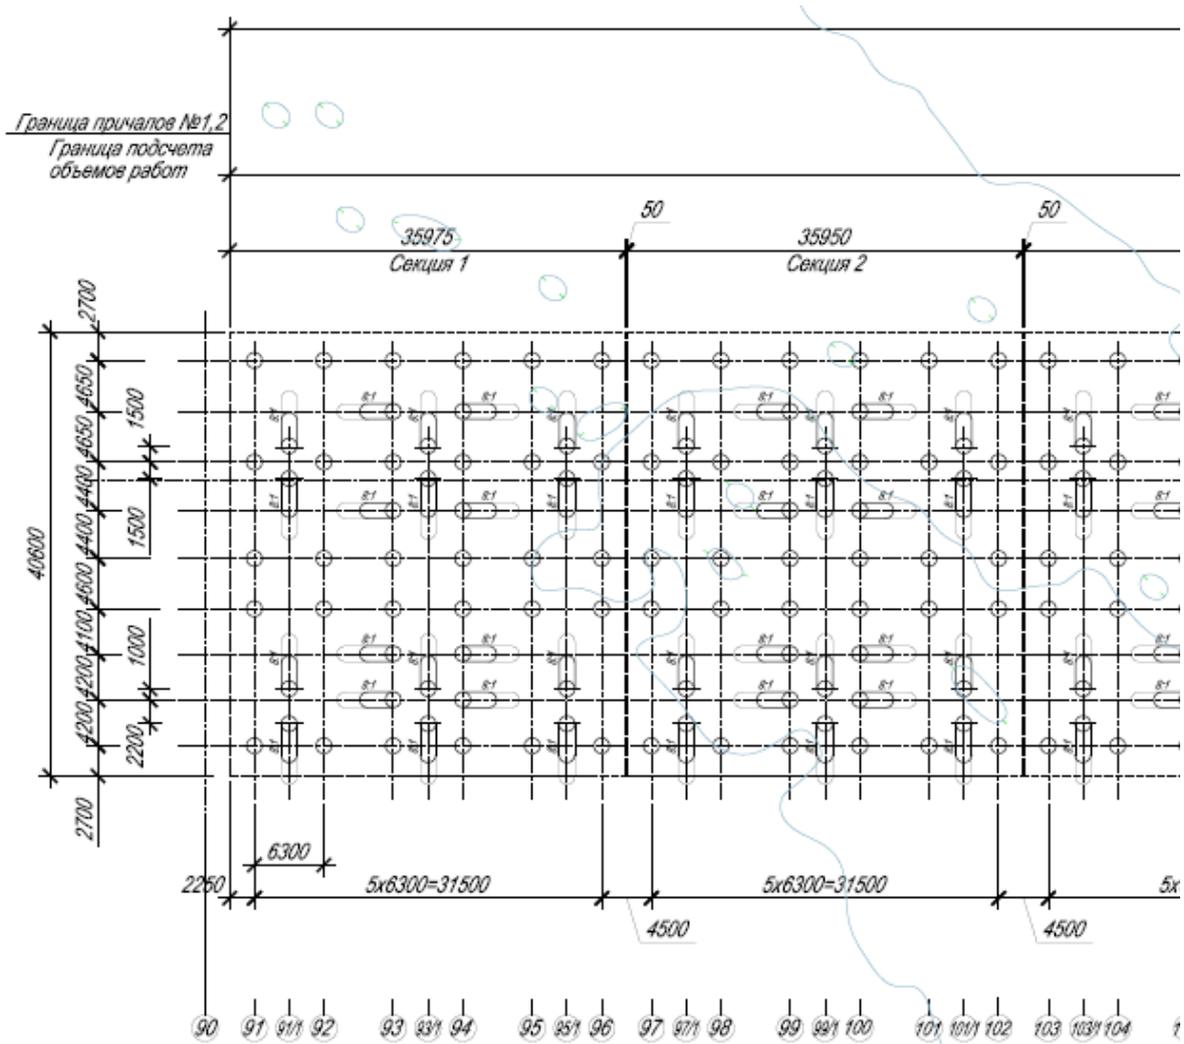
Фрагмент плана свайного основания 1, 2 причалов
